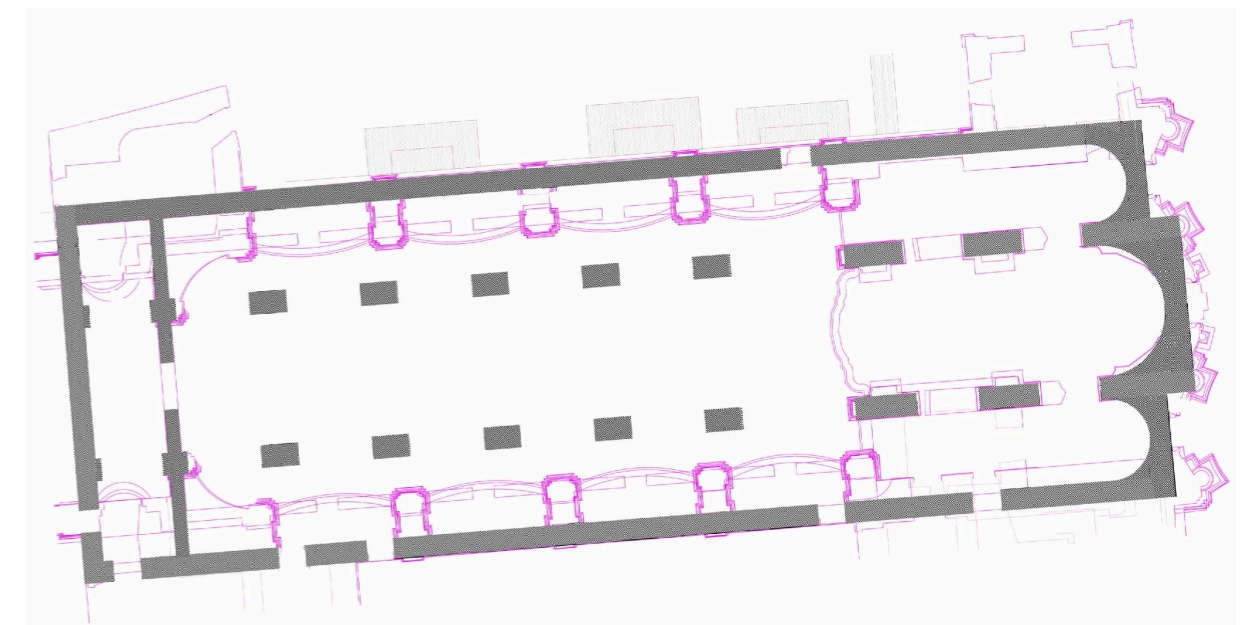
Stift Rein, Rekonstruktion des romanischen Gründungsbaus nach Elisabeth BRENNER (*Anm. 56, Plan 2, Kotierung entfernt*)
